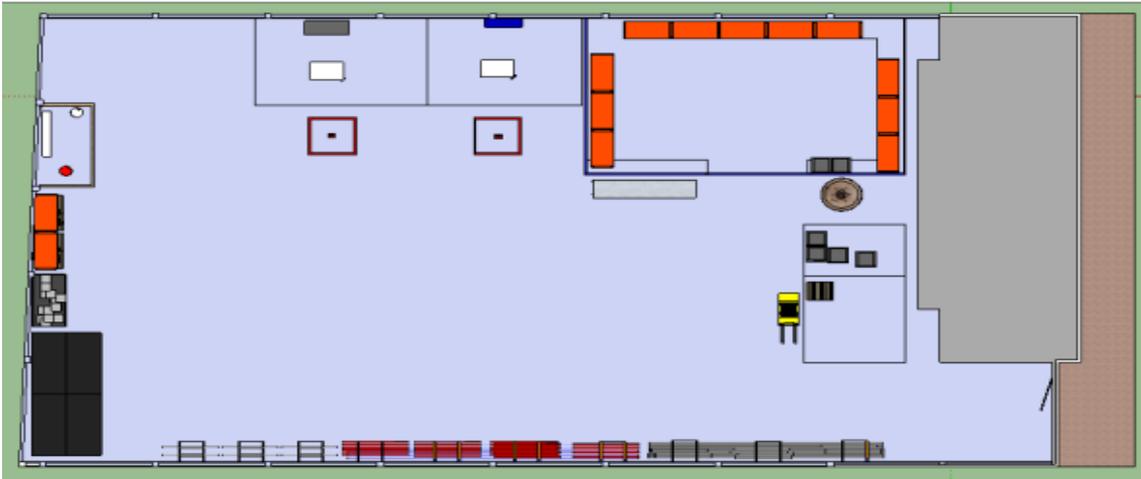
Plano esquemático de la planta y oficinas de la empresa
